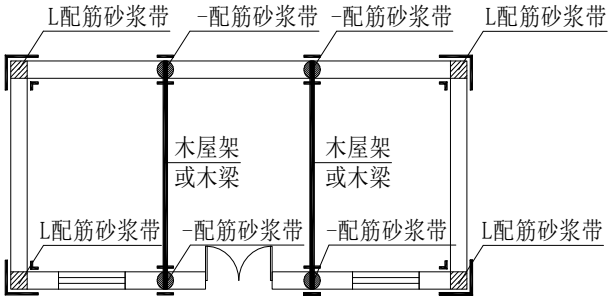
五间房水平配筋砂浆带布置平面示意图
